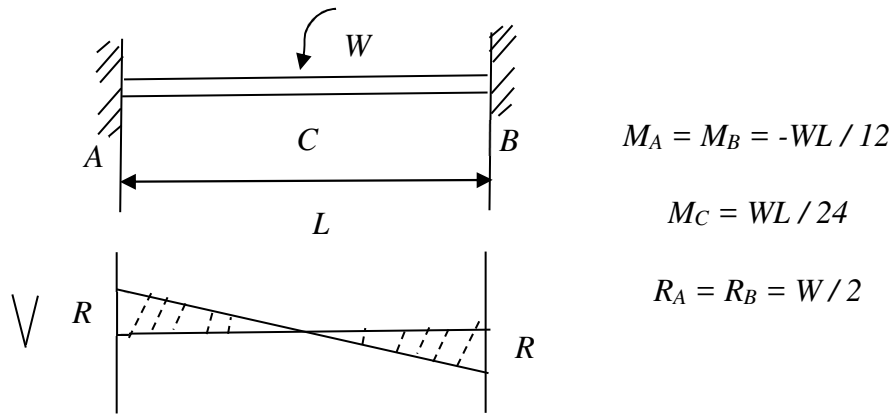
Formulas para vigas doblemente empotrada con carga distribuida
